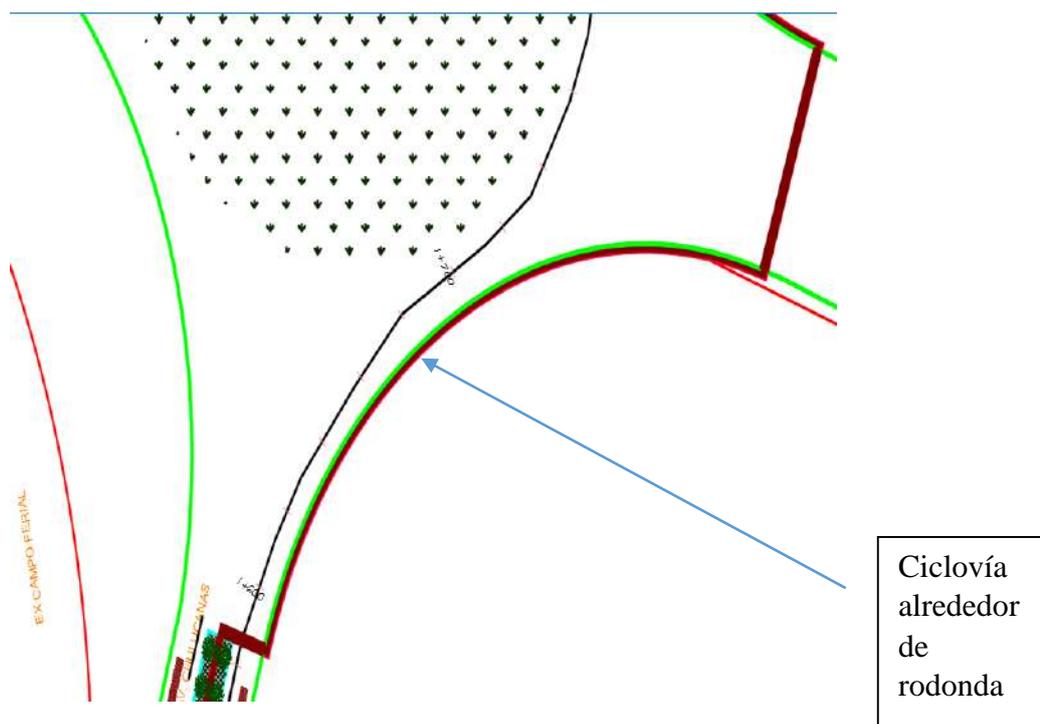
Ciclovía en Av. Chulucanas – Curvatura de rotonda. Vista en planta.
